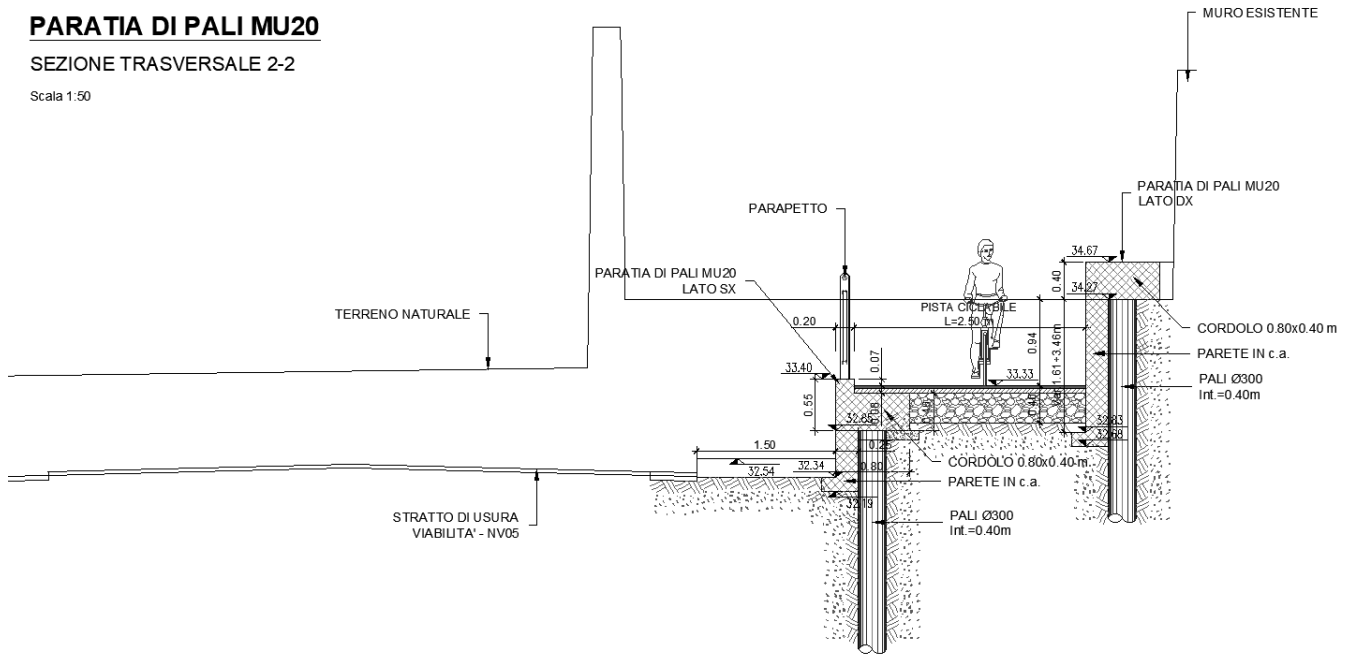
MU20 – sezione trasversale 2-2 – modello 2
